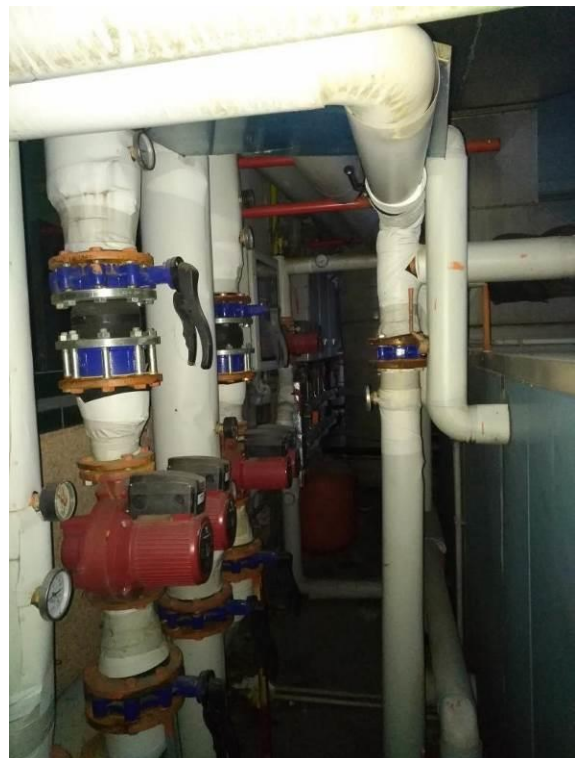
/43 – Impianto a servizio dell'hotel (sub 701) e panificio (sub 702)
